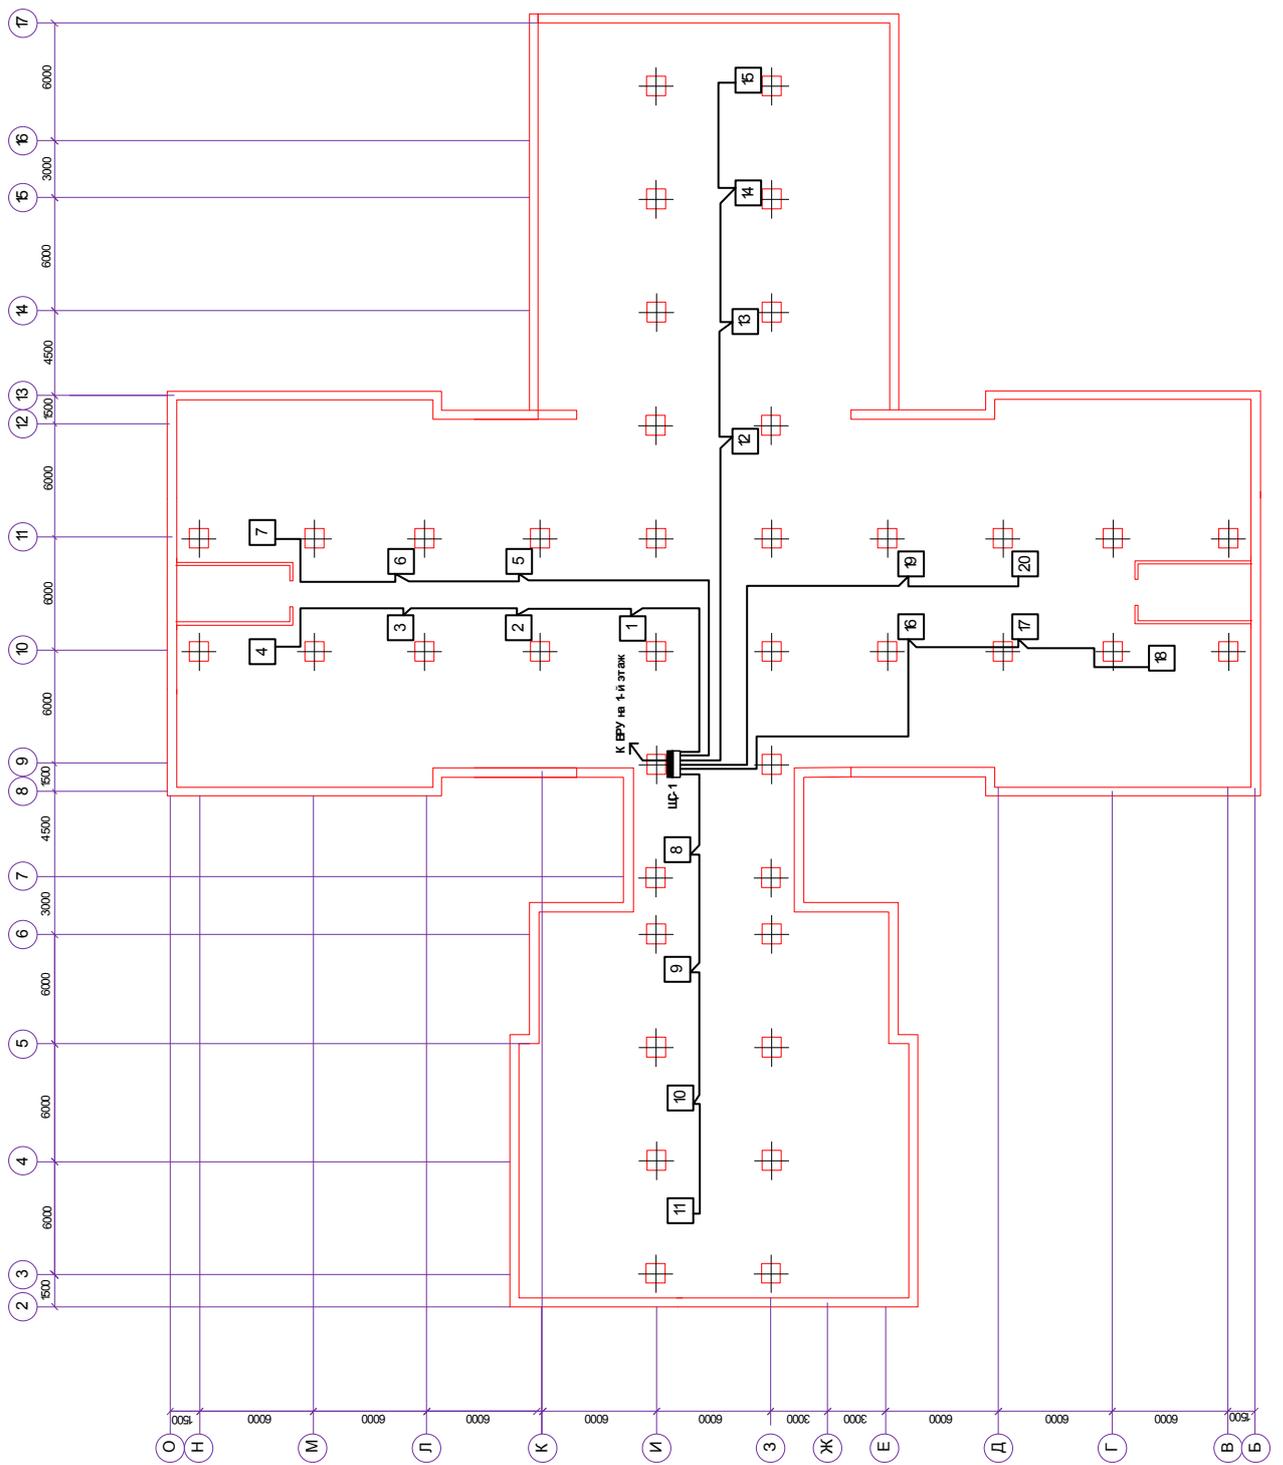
План силовых сетей чердака детского сада (вентиляция)
